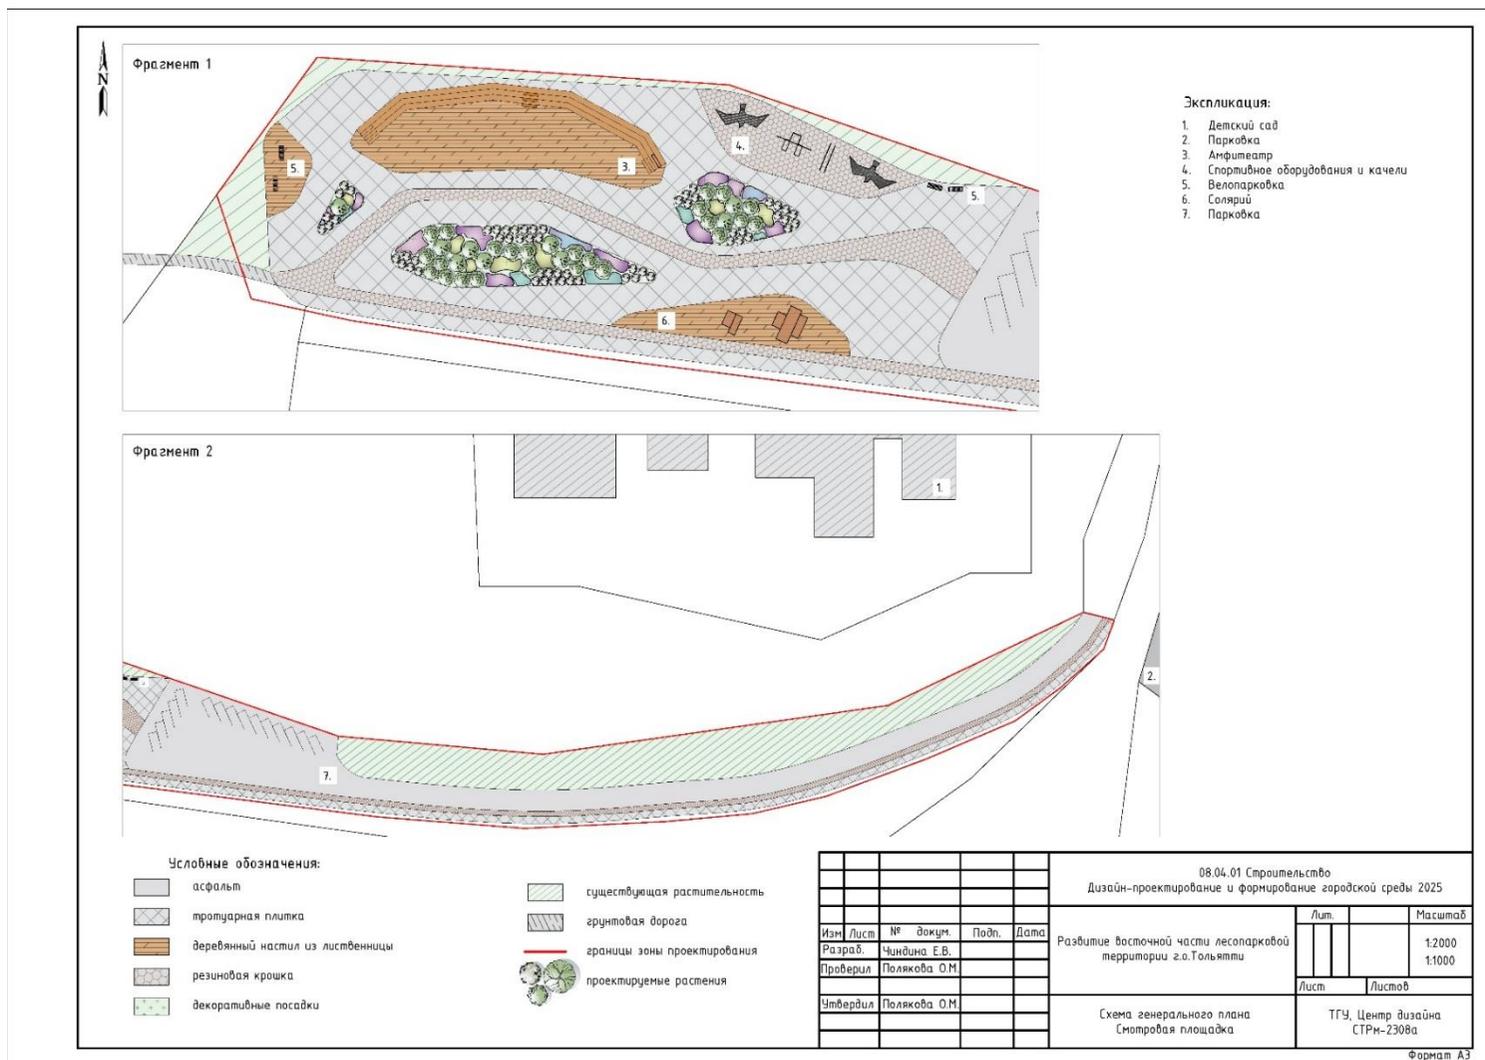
Фрагмент схемы генерального плана. Зона «Смотровая площадка»
